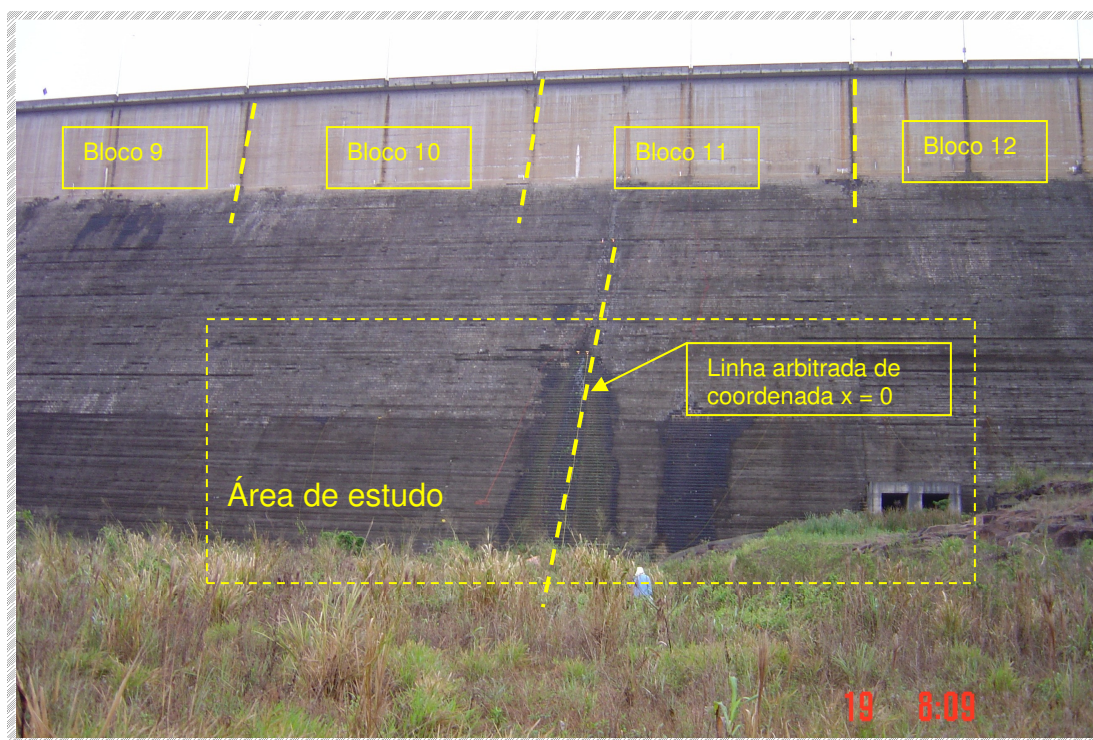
Área de estudo na rampa jusante da UHE de Salto Caixas (zona de fissura do Bloco B11).
